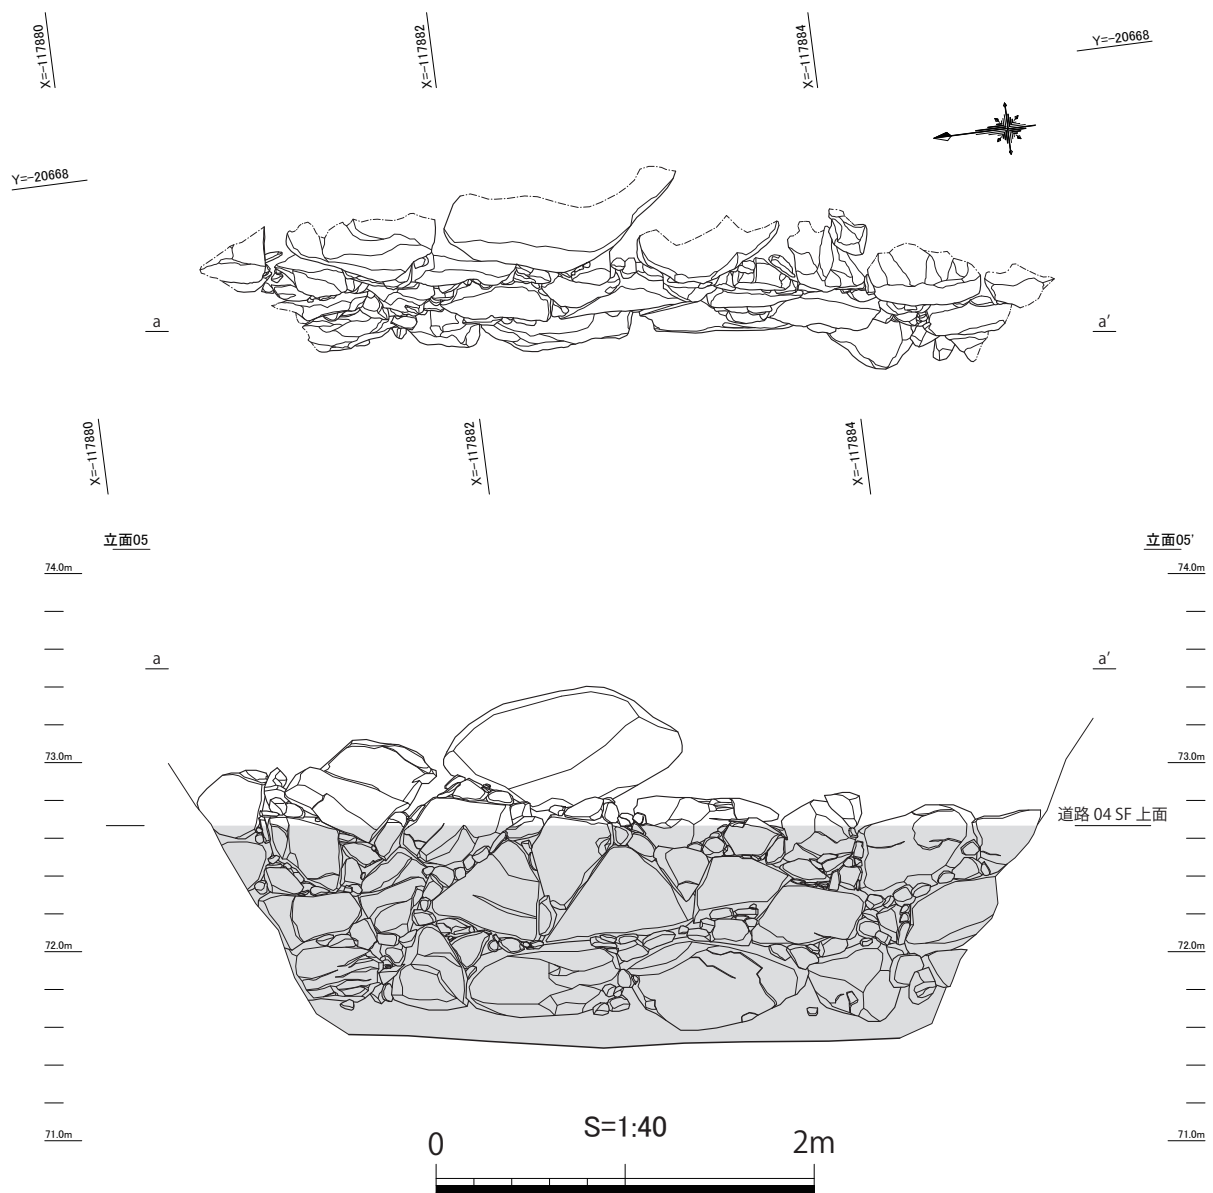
石垣 01SL 平面図・立面図 (1 : 40)
